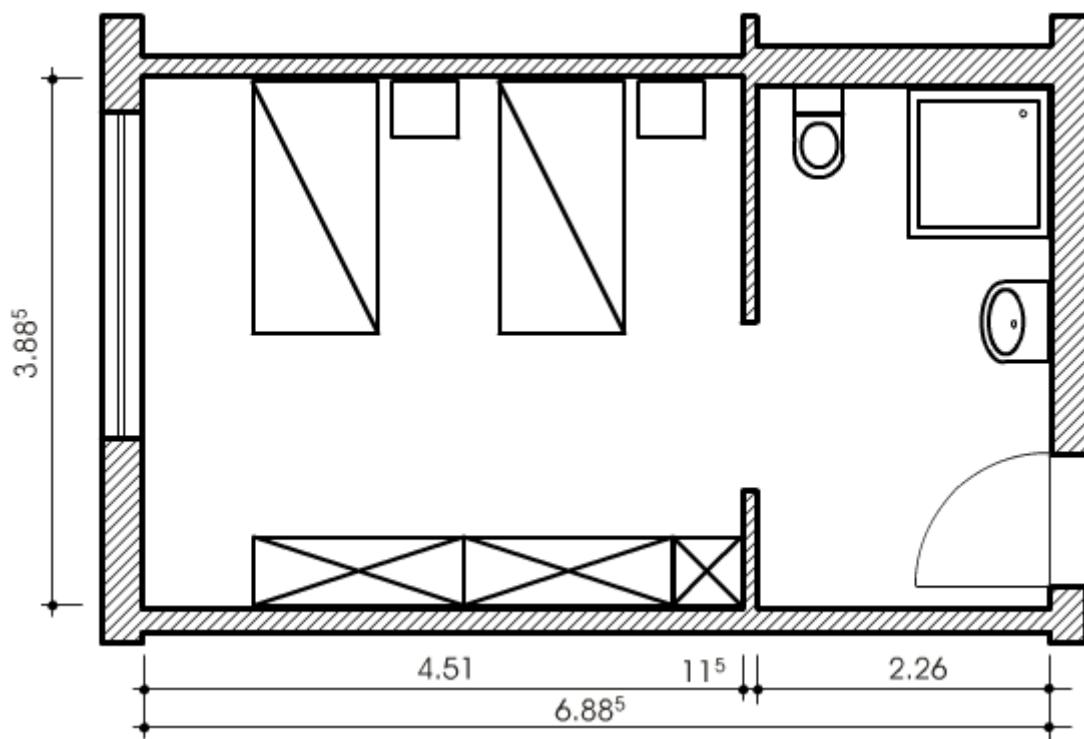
Grundriss eines Zimmers mit Bemaßung und Einrichtung
